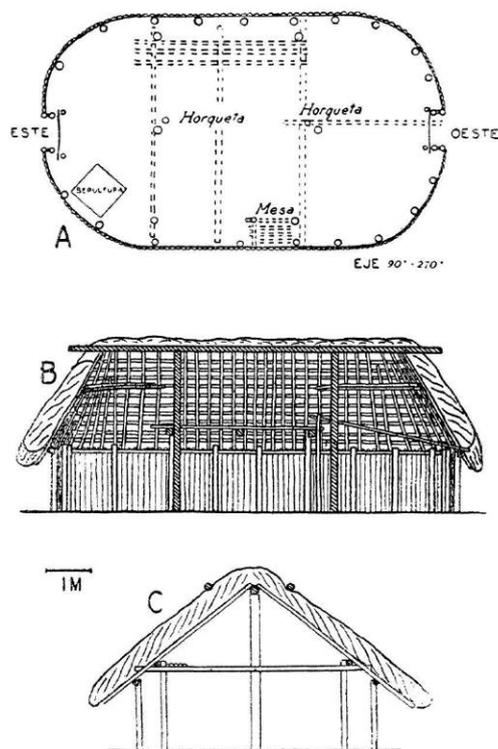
Planta y secciones de la vivienda oblonga kamarakota (Parapan).
